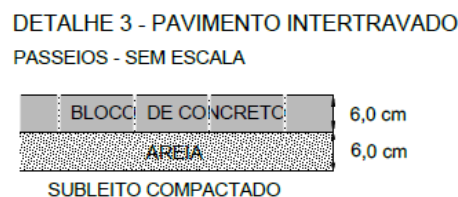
Pavimento Intertravado Calçada de 6 cm
